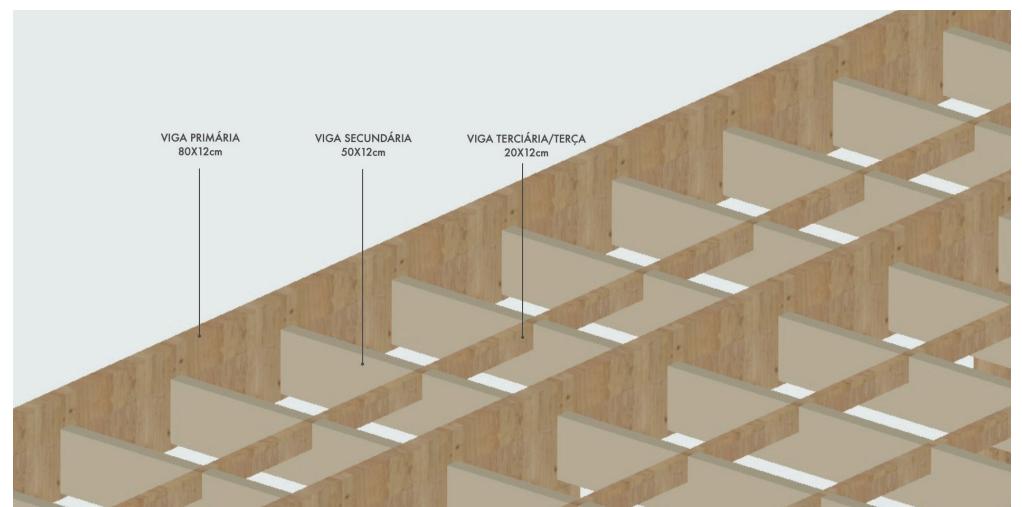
Grelha de cobertura: Perspectiva vigas e suas dimensões. Fonte: Autora.
